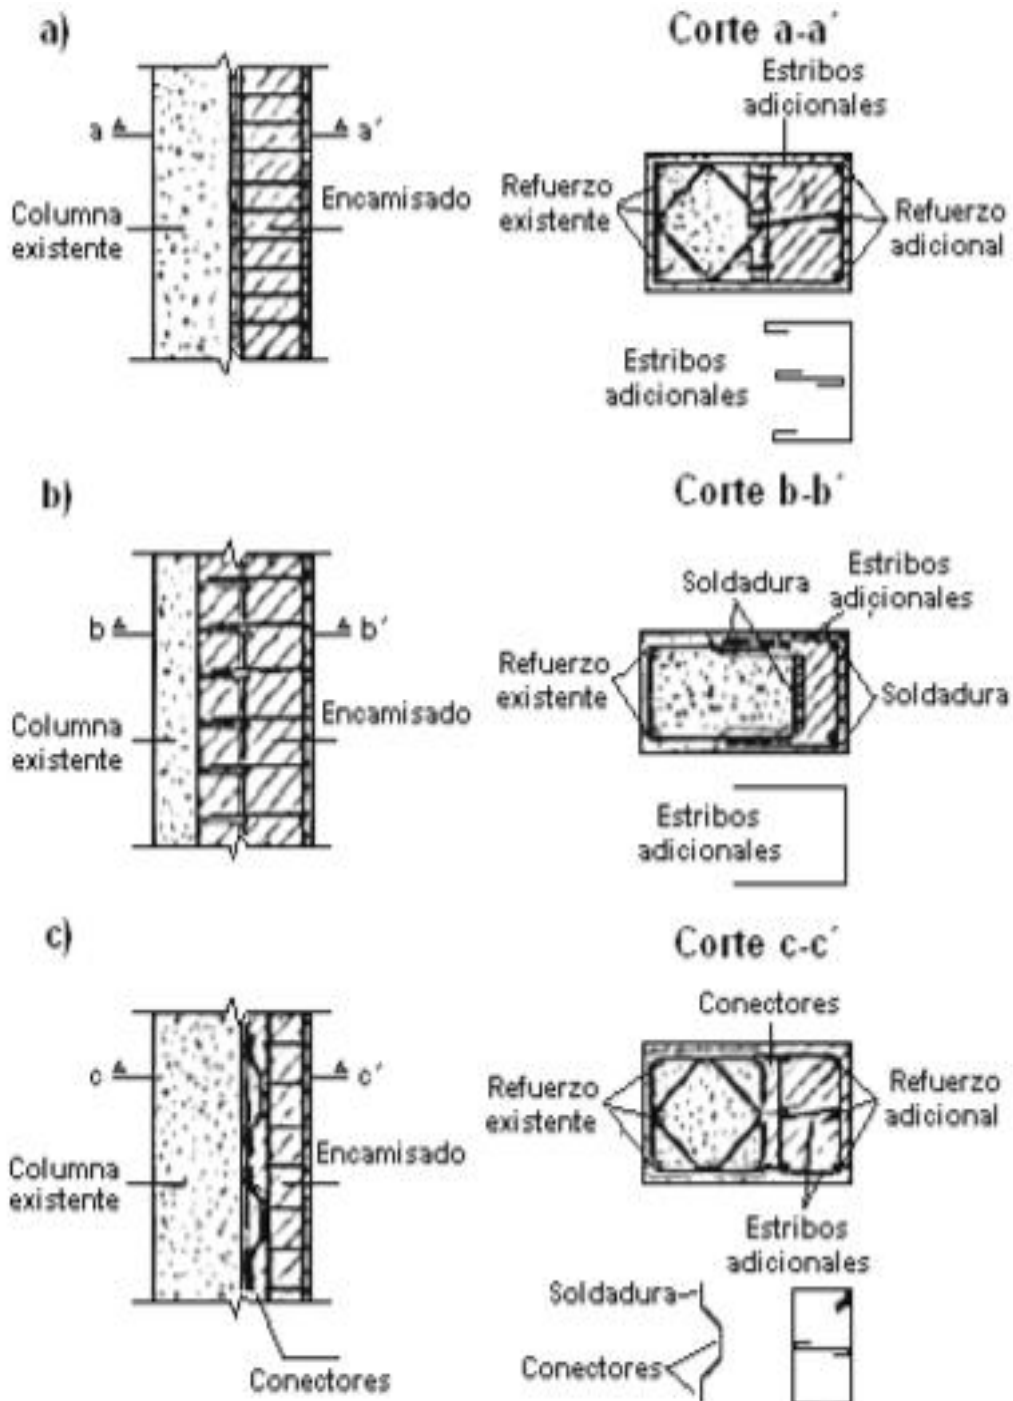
, Encamisado parcial de columnas (UNDP/UNIDO, 1983)
